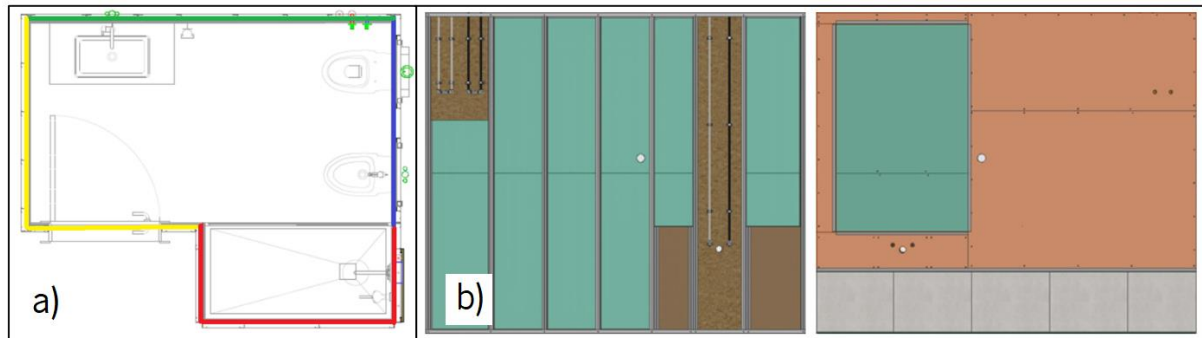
a) Planta do WC; b) Representação 3D de uma parede do WC
